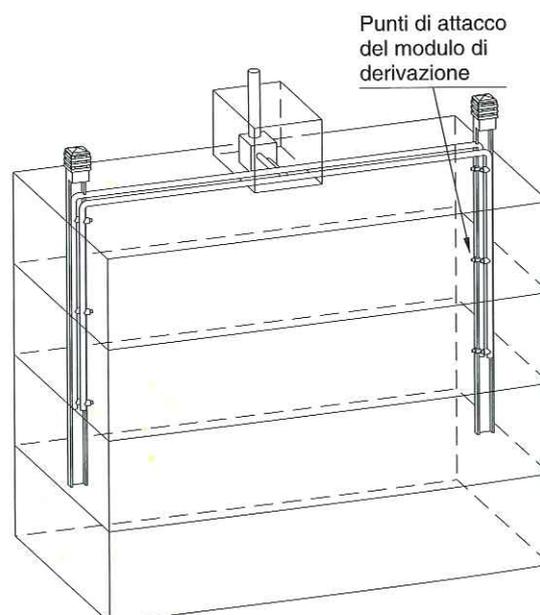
Centrale termica situata sul tetto dell'edificio.
